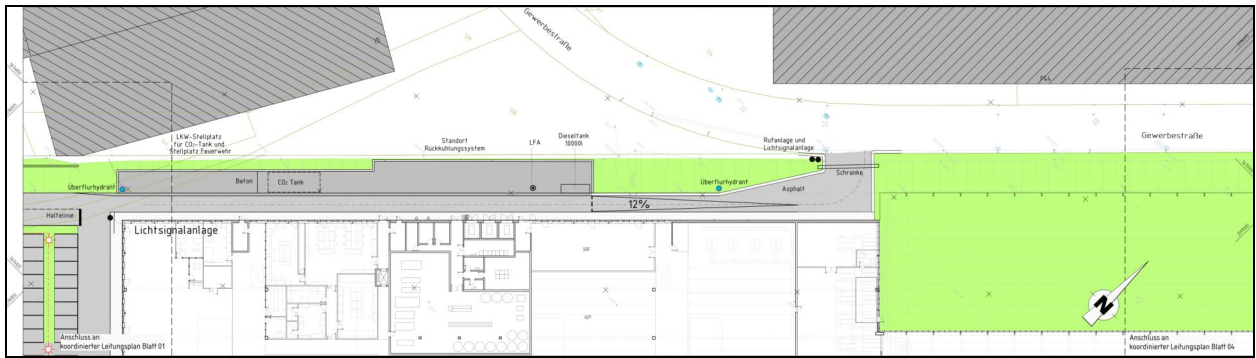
Lageplan Mitte des geplanten Standorts der Firma Gira
